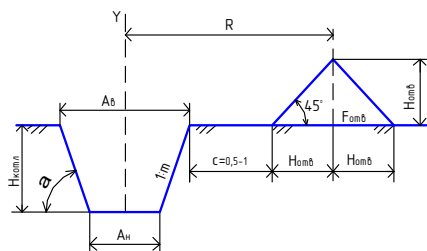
Поперечный разрез котлована (траншеи) и отвала грунта
